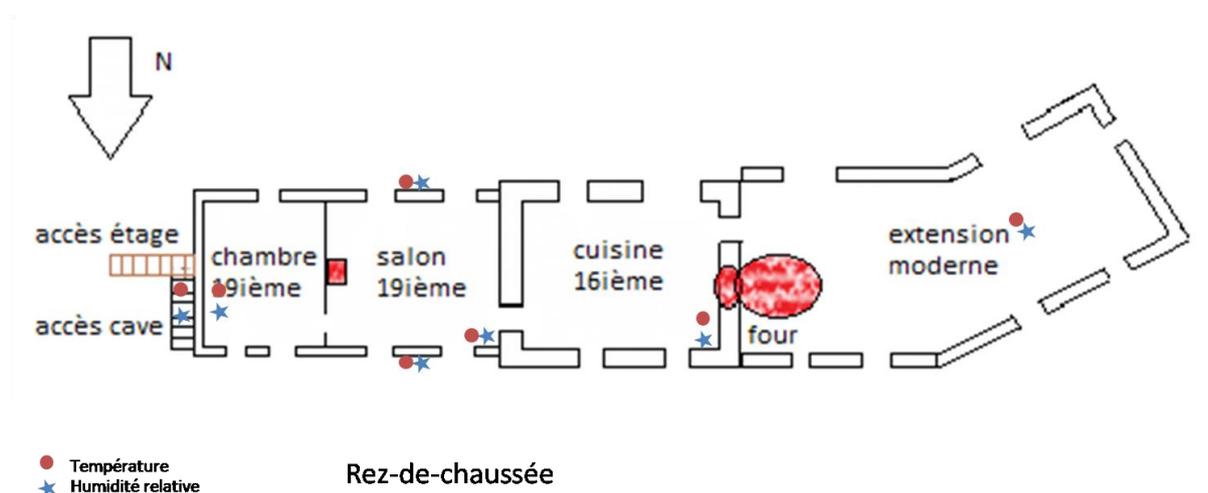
Plan de l'instrumentation du rez-de-chaussée
